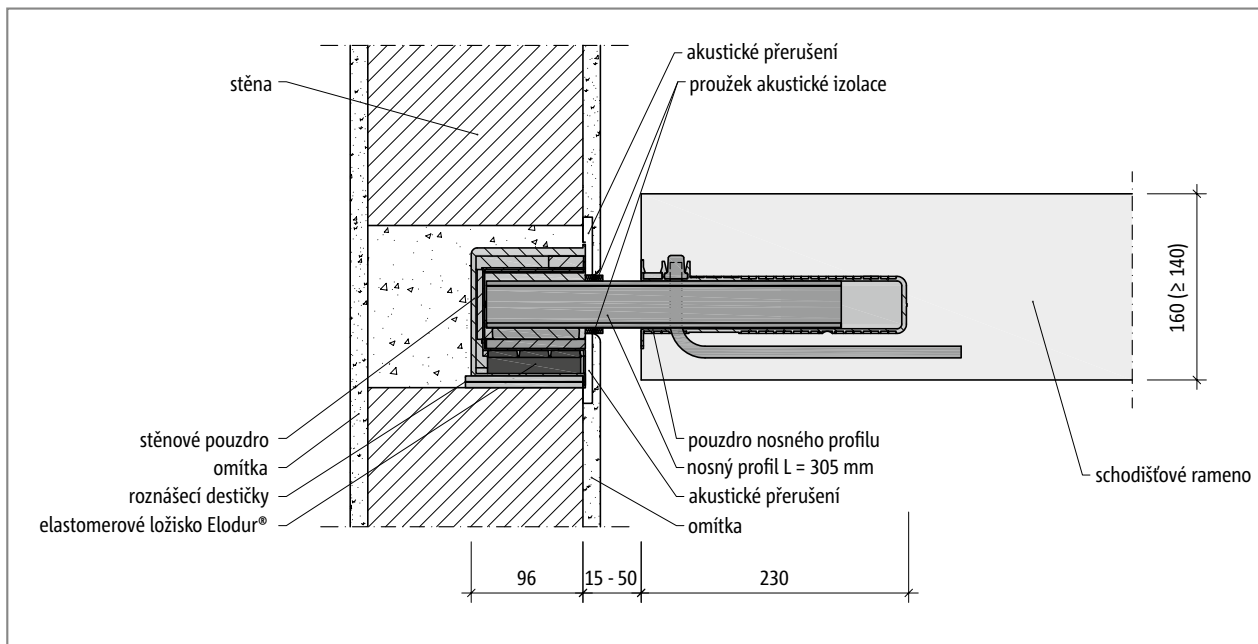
Schöck Tronsole® typ Q-FV nebo Q-A2: Řez napojením ramene a stěny
